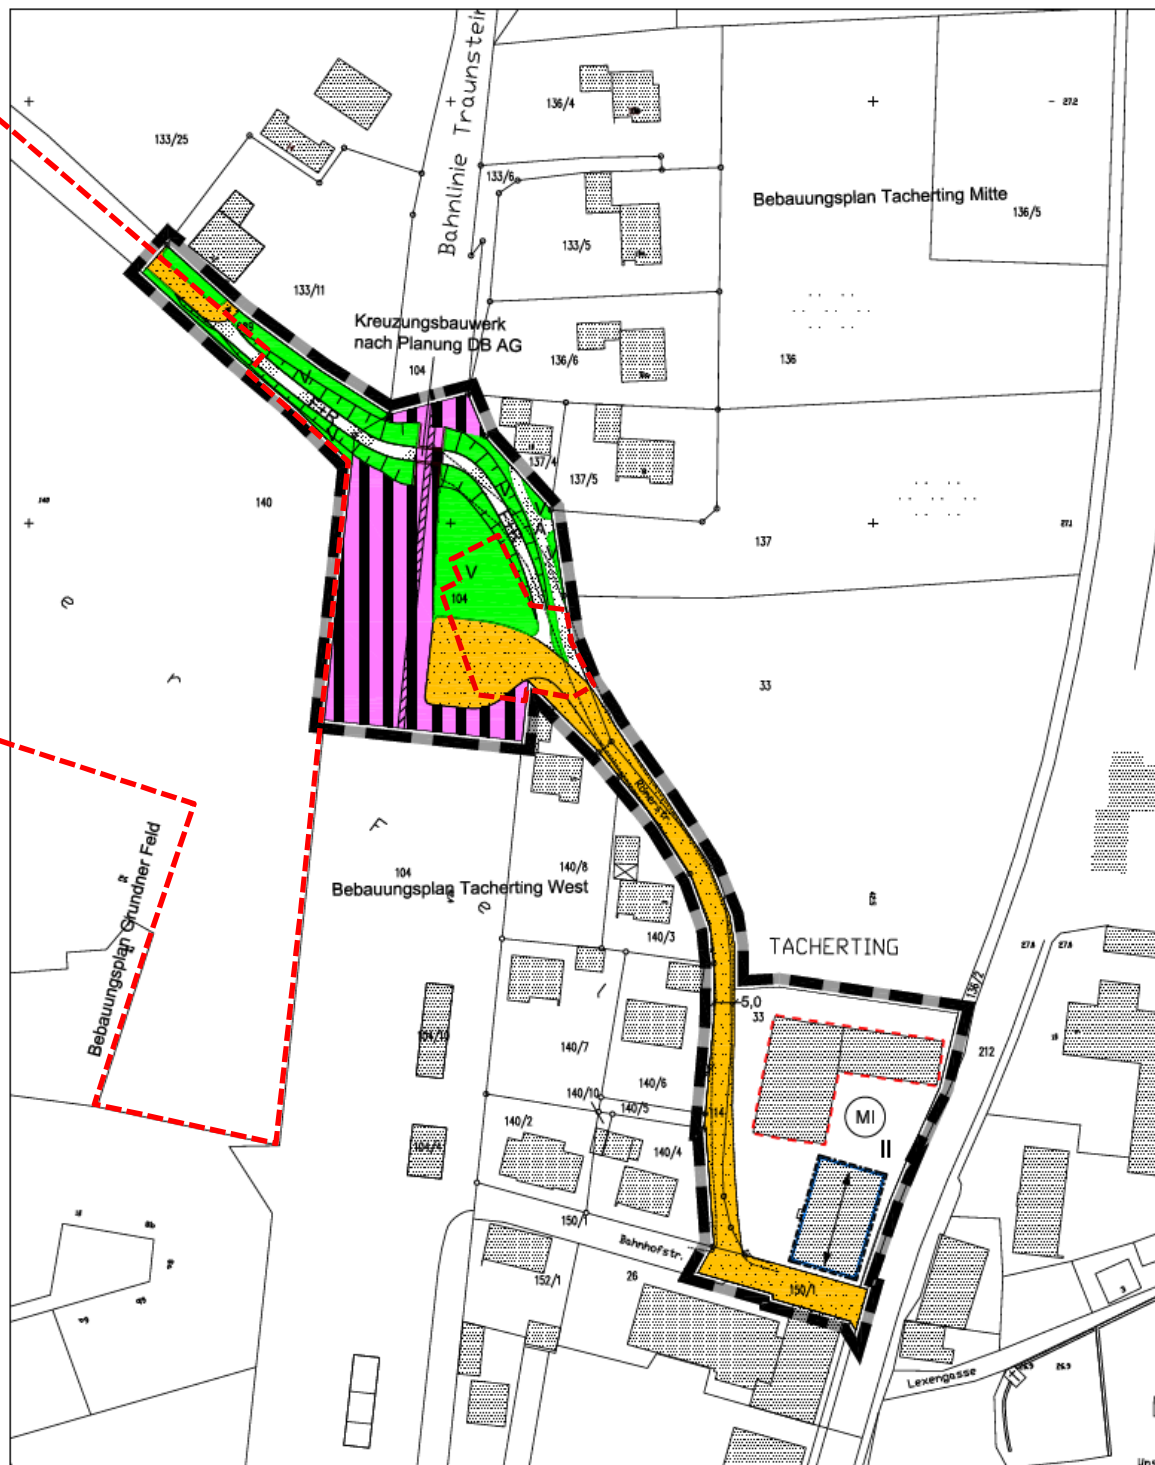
„Teilbereich 4: Römerstrasse“ des Bebauungsplans „Bahnübergänge“ der Gemeinde Tacherting (Geltungsbereiche des gegenständlichen Bebauungsplans rot) - ohne Maßstab
